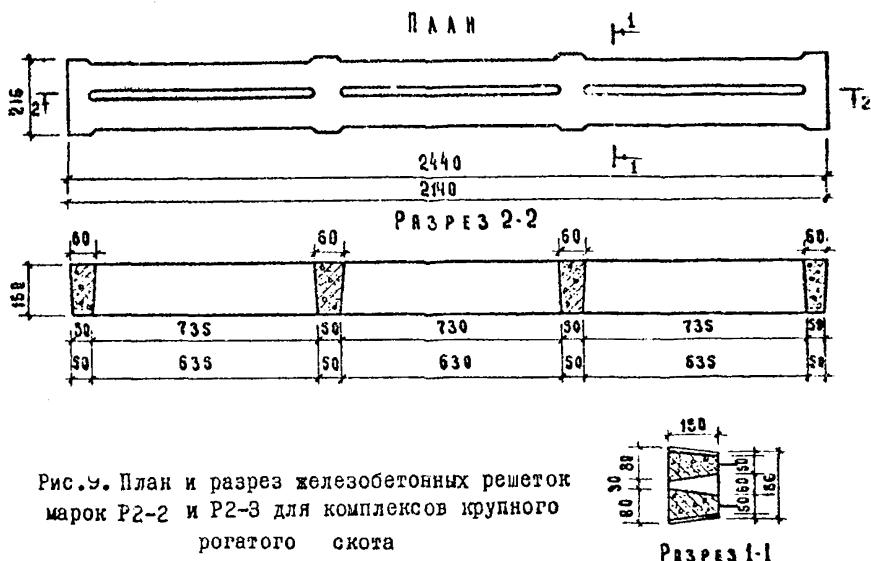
План и разрез железобетонных решеток марок Р2-2 и Р2-3 для комплексов крупного рогатого скота
